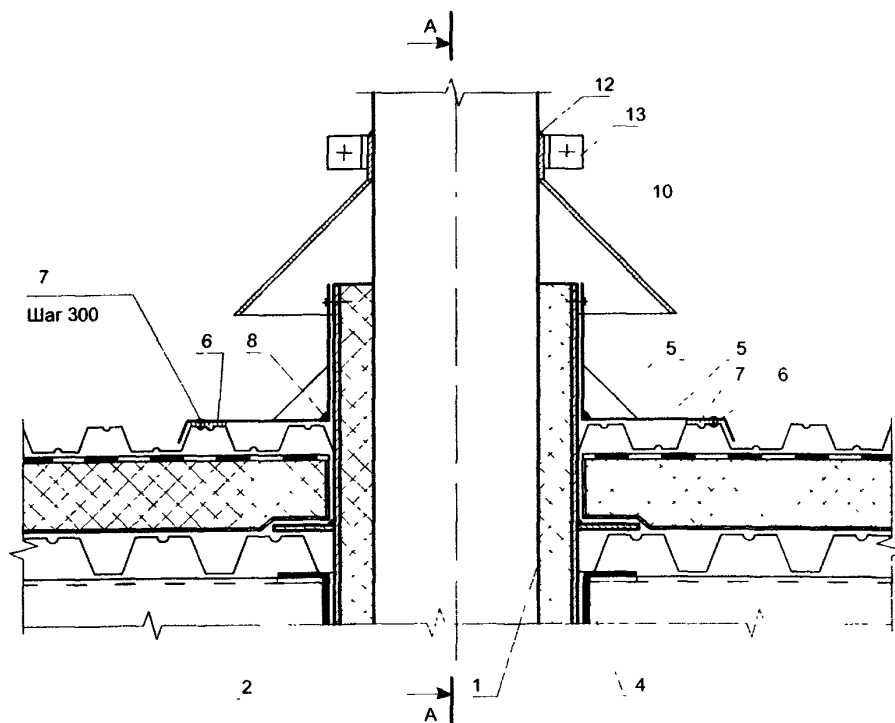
Герметизация примыкания кровли к кирпичной трубе.
